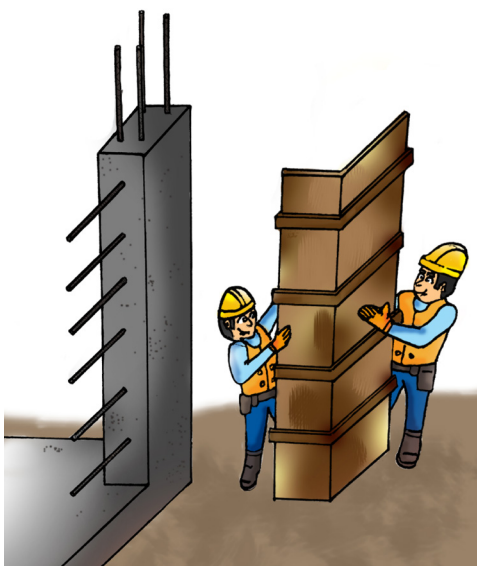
Muro estructural de mampostería confinada, tipo 2 (se construyen las columnas, se dejan chicotes o varillas horizontales y luego se construyen los muros anclados a las columnas mediante los chicotes).
